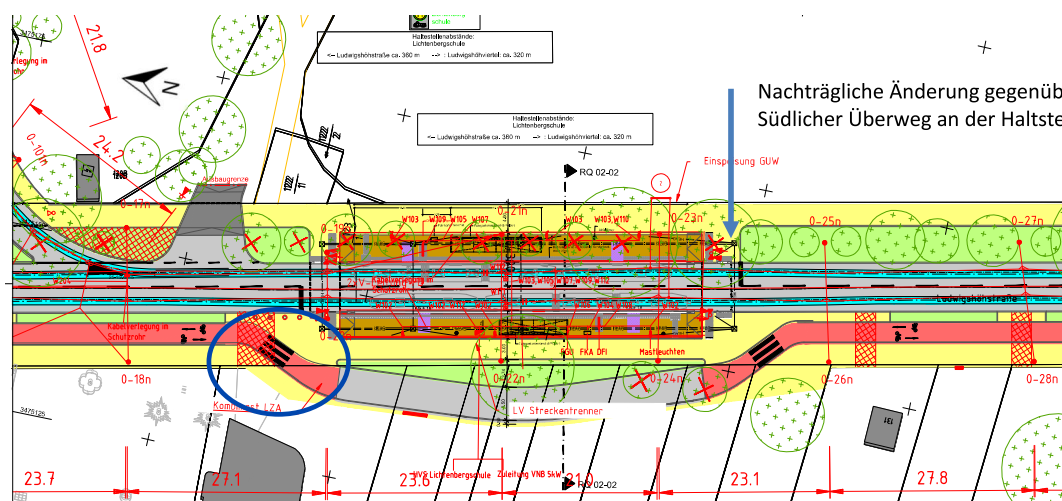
Lageplan Lichtenbergschule – Ludwigshöhstraße, Zufahrt Lehrerparkplatz markiert (Auszug [R1])
